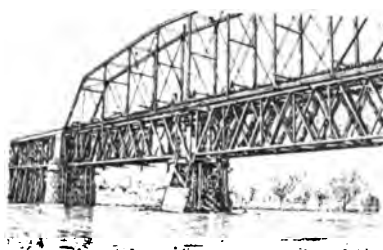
Vue du pont d'Irvine, monté, sur ses échafaudages, pendant la crue (d'après l'Engineering News).
